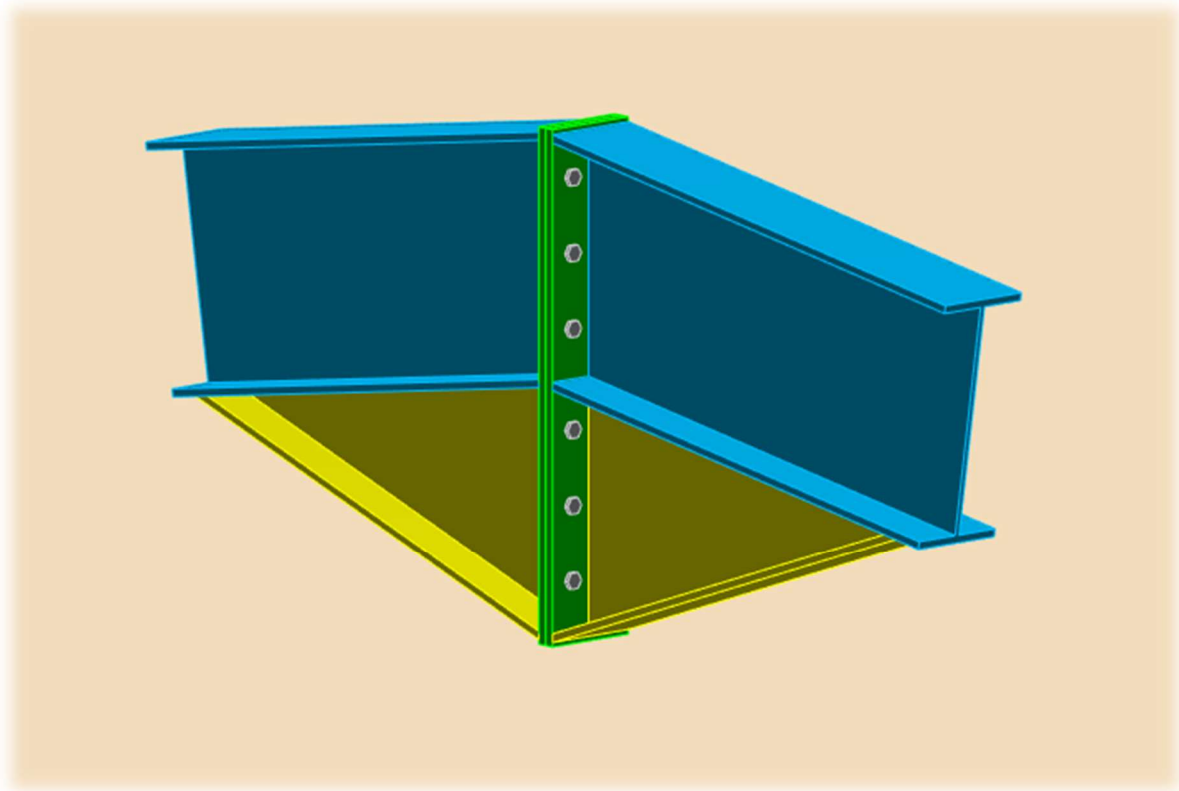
3D d'assemblage poteau - traverse (IPE500-IPE500)
